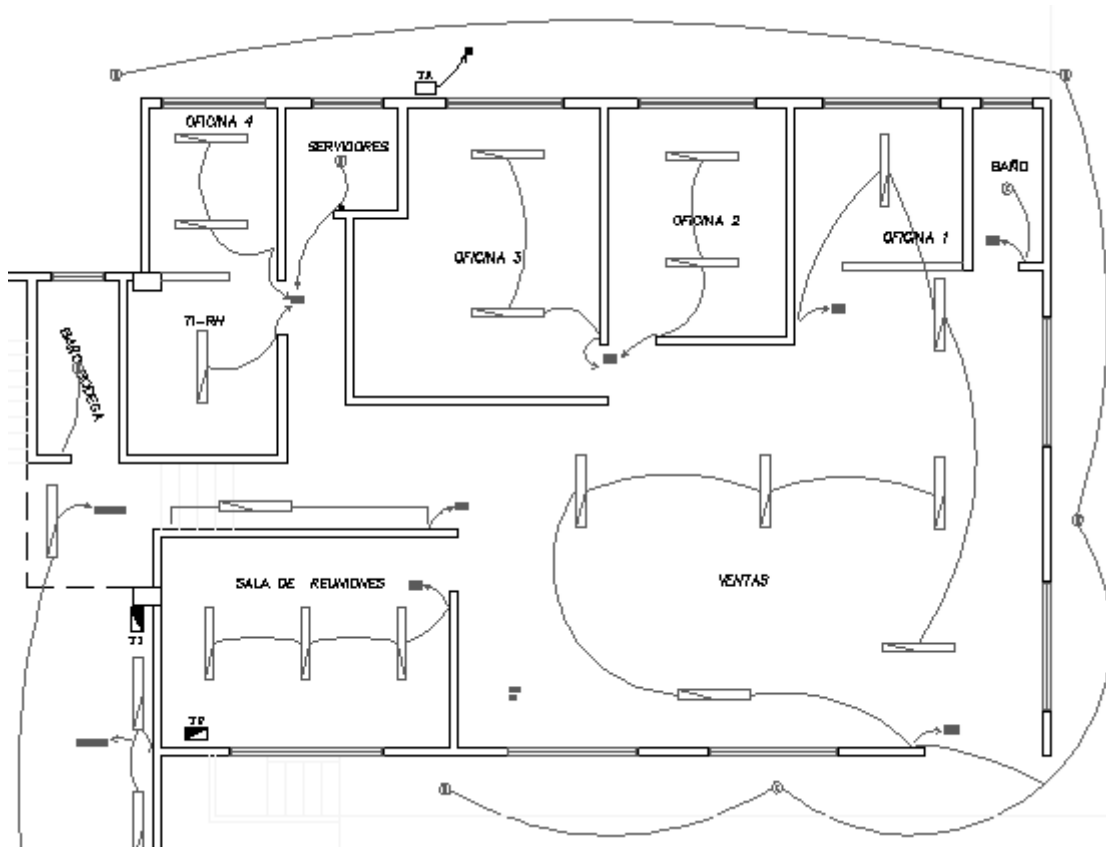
Fragmento de plano eléctrico con el detalle de luminarias.
